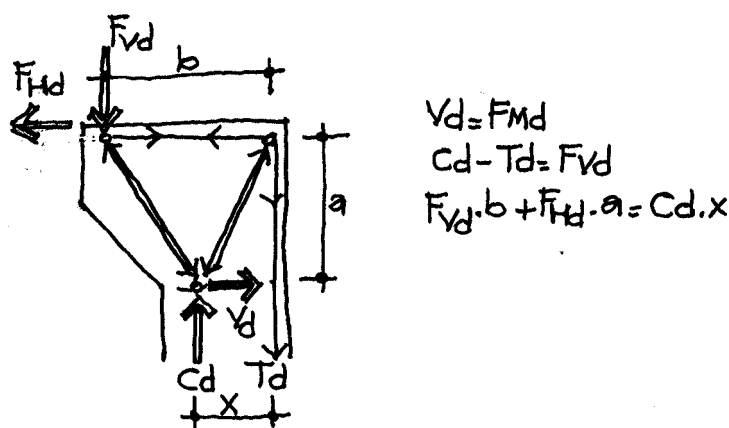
Planteamiento de las condiciones de equilibrio en una parte de estructura.
